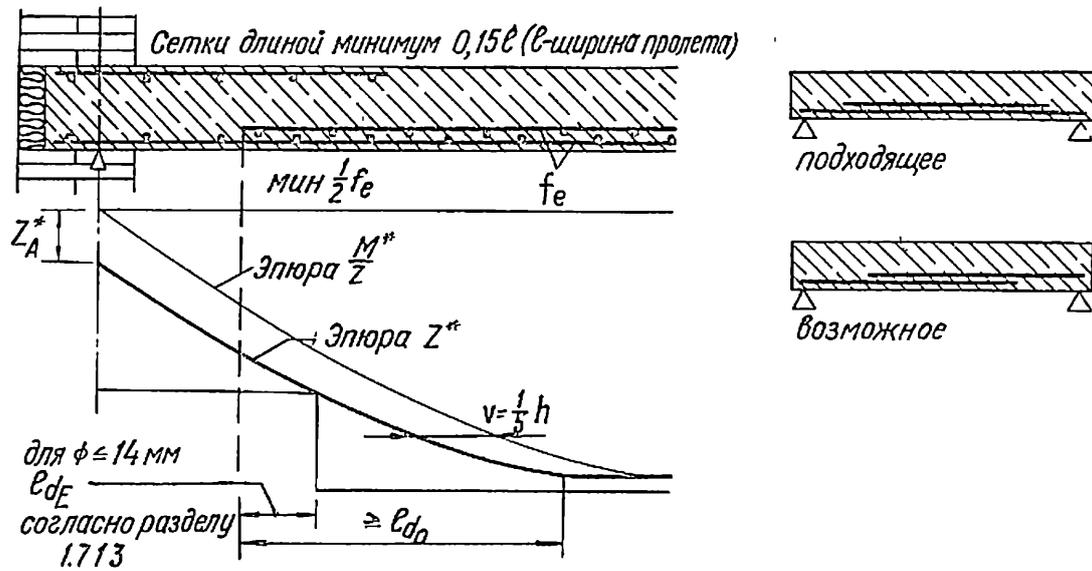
2. Пример уменьшения сечения арматуры к опорам при применении сеток
